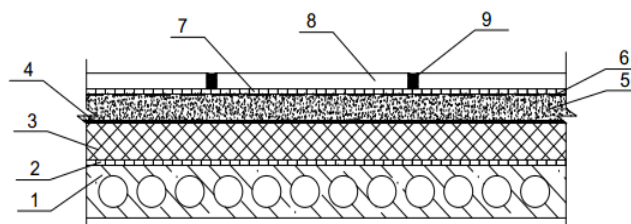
Структура теплоізоляції перекриття у ванних кімнатах, душових та вбиральнях, кухнях із використанням багатопустотних плит на першому поверсі 1 – багатопустотна залізобетонна плита; 2 – клейовий шар для кріплення утеплювача; 3 – утеплювач; 4 – пароізоляція; 5 – покриття вирівнювальної стяжки; 6 – грунтовка на водній основі; 7 – клейовий шар для закріплення керамічної плитки; 8 – керамічна плитка; 9 – затирка для швів між керамічними плитками.
